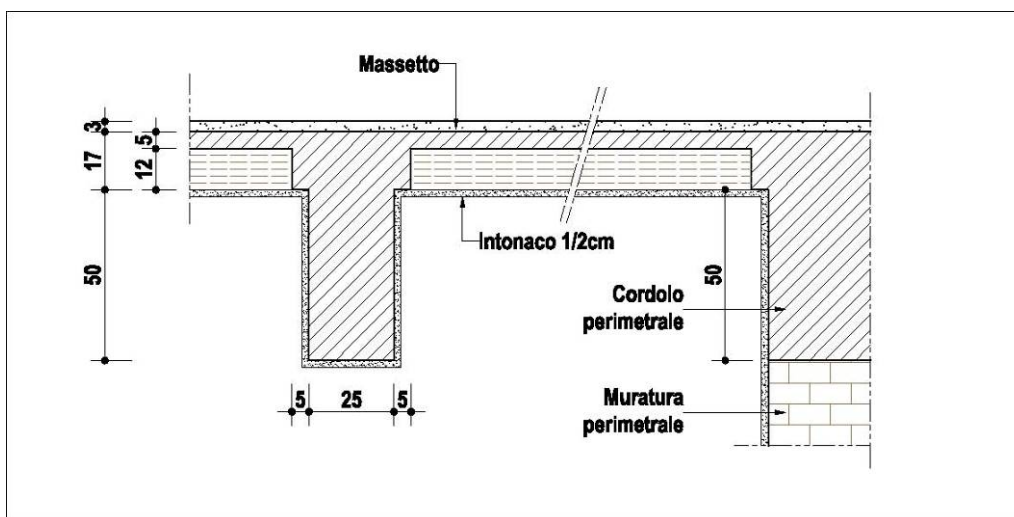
Solaio P. Sottotetto – Ala est – Cordolo perimetrale e solaio latero-cemento
